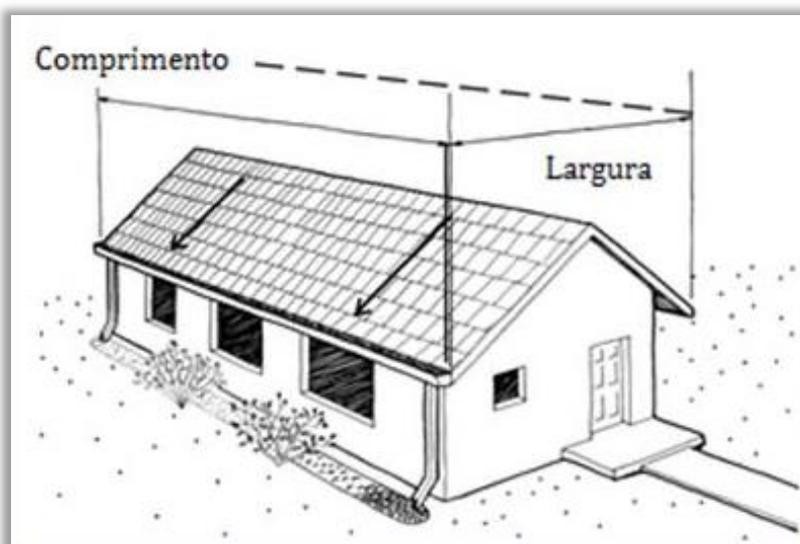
Área de Coleta de água de um telhado ou laje.
